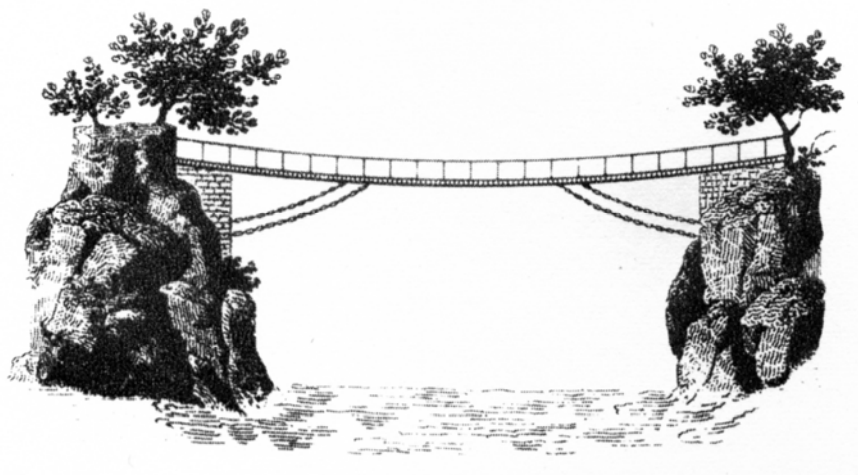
Disegno del Winch Bridge (Gran Bretagna, 1741) luce 21 m
